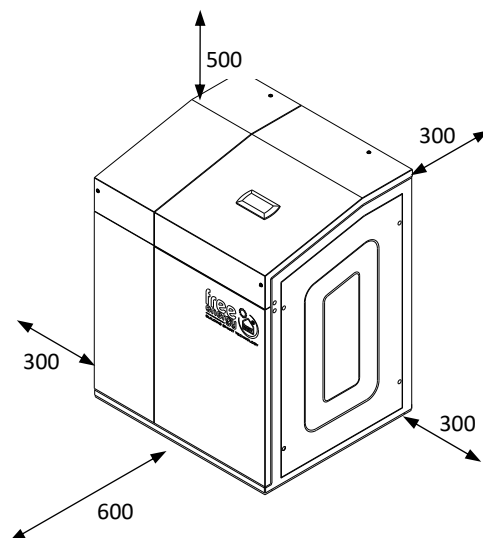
Rekommenderade minimimått runt värmepumpen (mått i mm).
